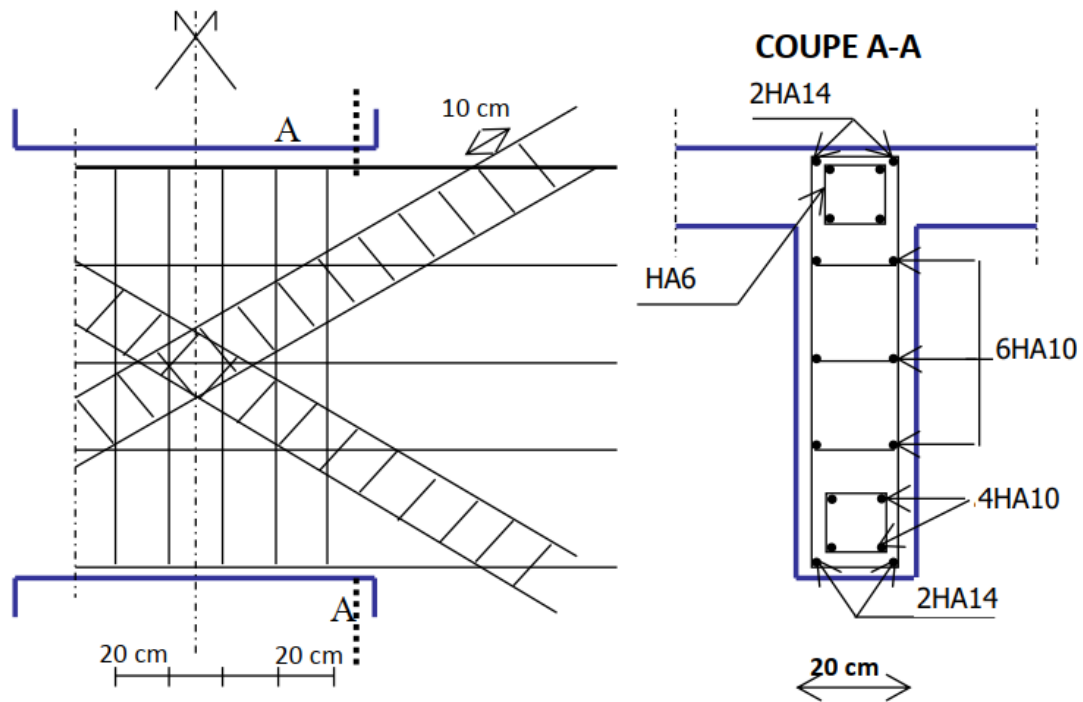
Schéma de ferrailage des voiles avec ouverture.
